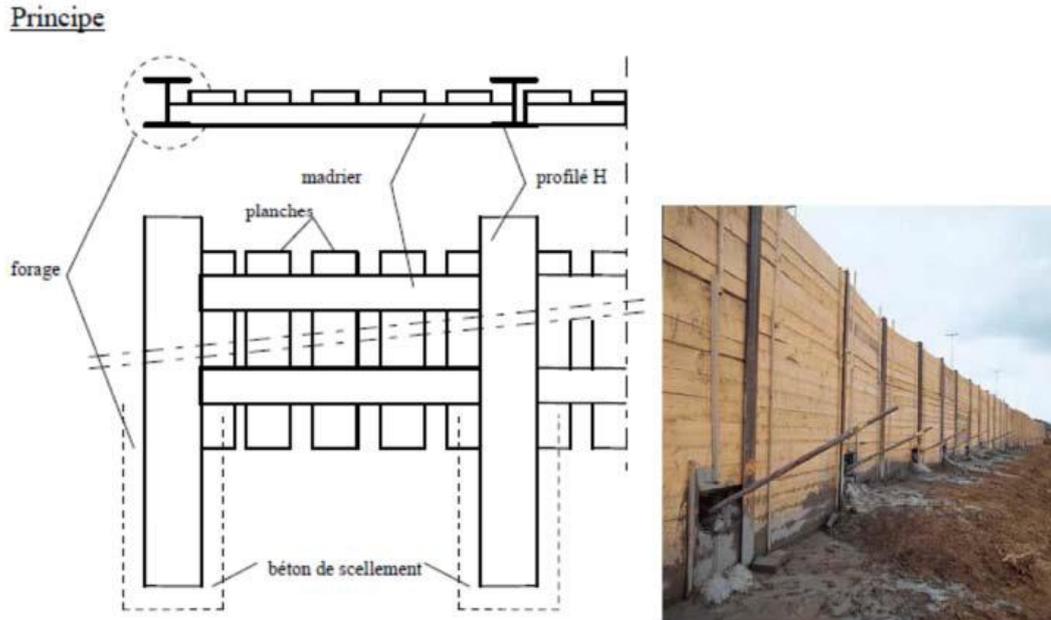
Schéma de principe de la paroi berlinoise traditionnelle
